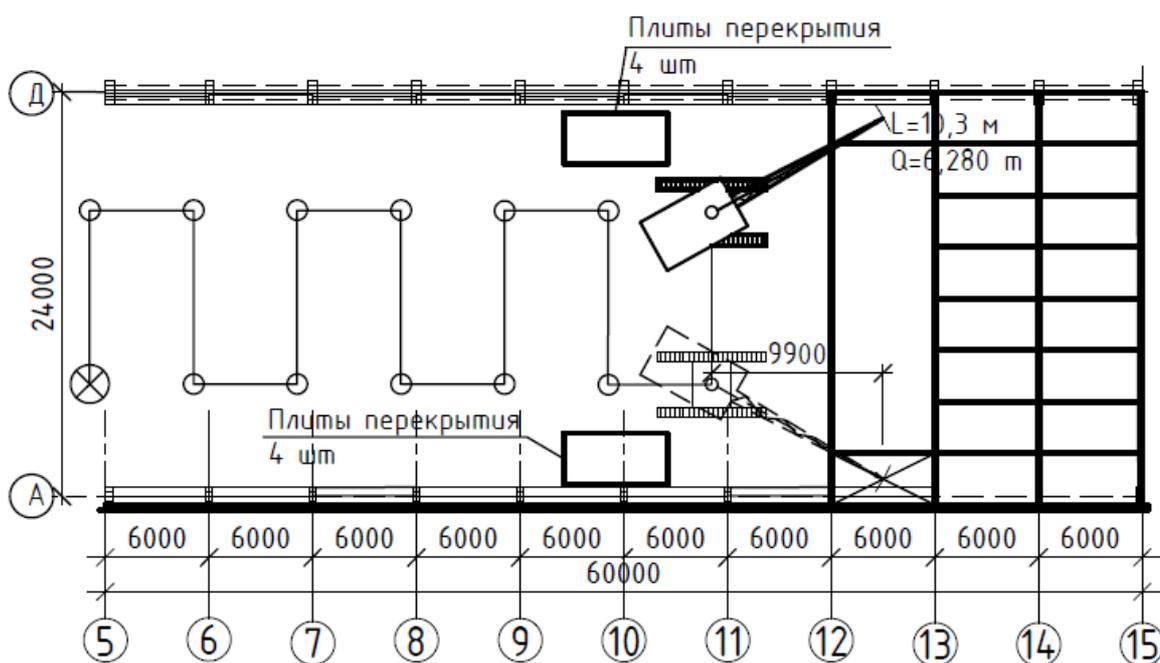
Схема проходки крана при монтаже элементов покрытия (стропильных ферм и плит) в пролете А-Д (5-15)., выполнил Наумов Р.С.гр. ТСНК-18
